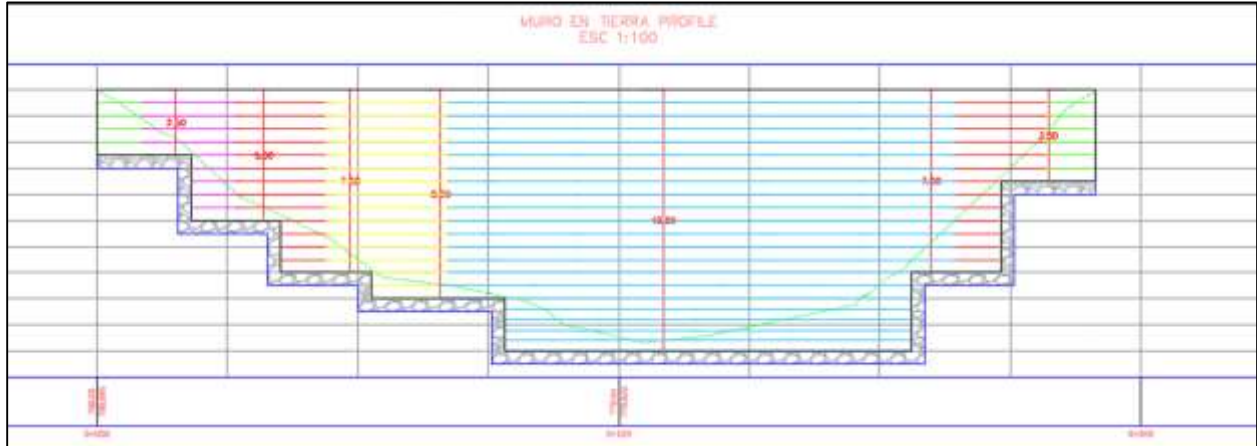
Perfil muro ubicado en La Pradera Girón.
